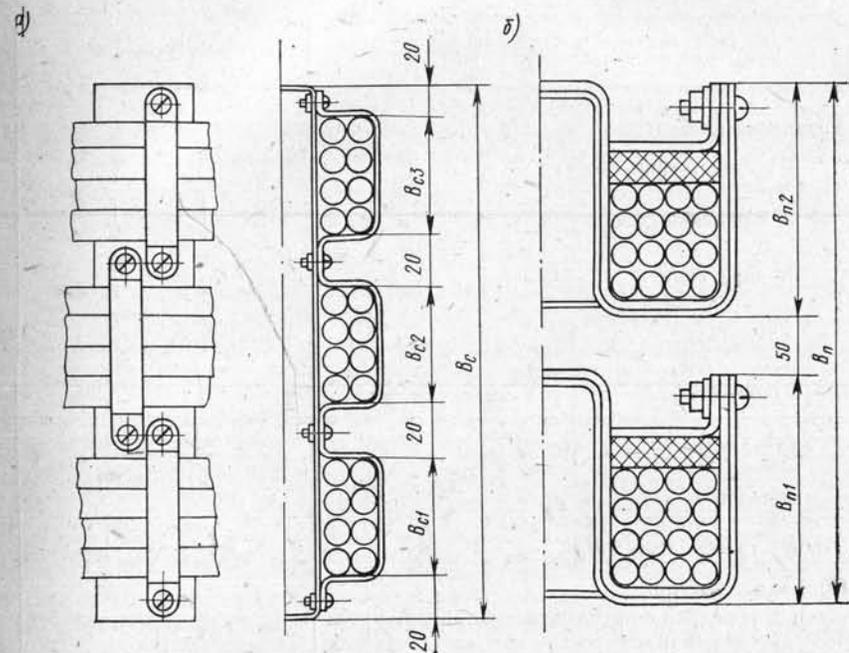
К определению габаритного размера трассы при креплении кабелей; а — скобами; б — в подвесках.
